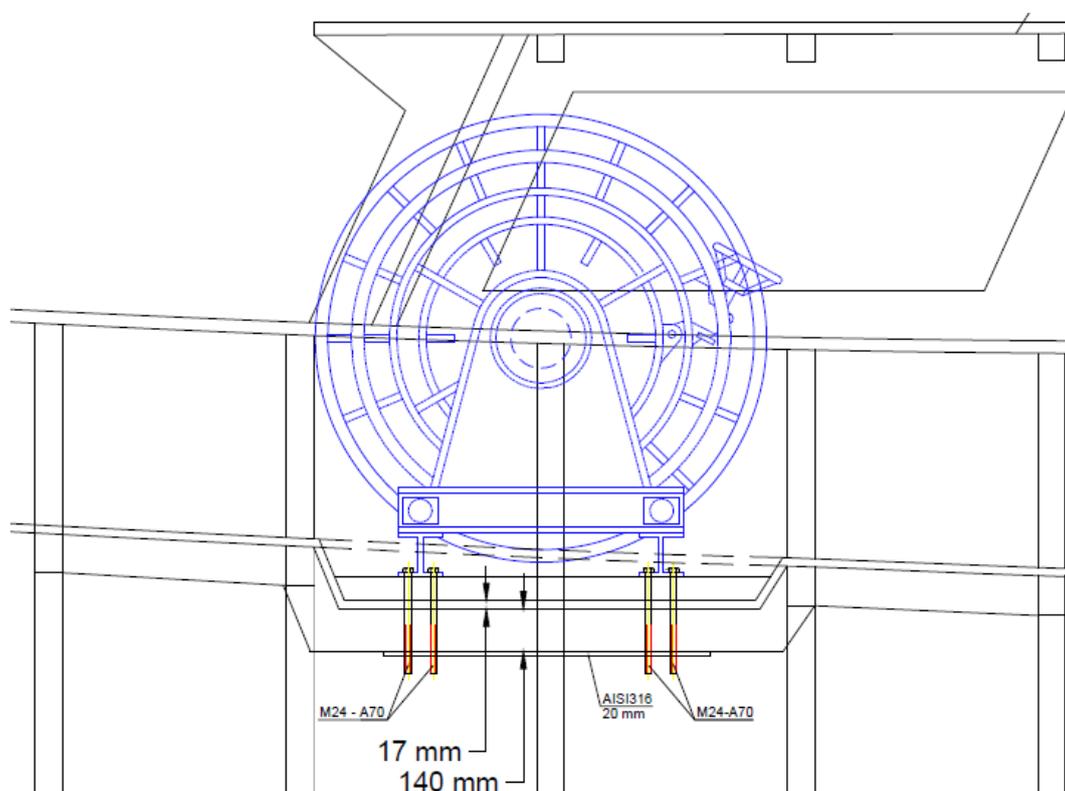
Esquema de la reparación efectuada en cubierta (fuente: proyecto de reparación)
